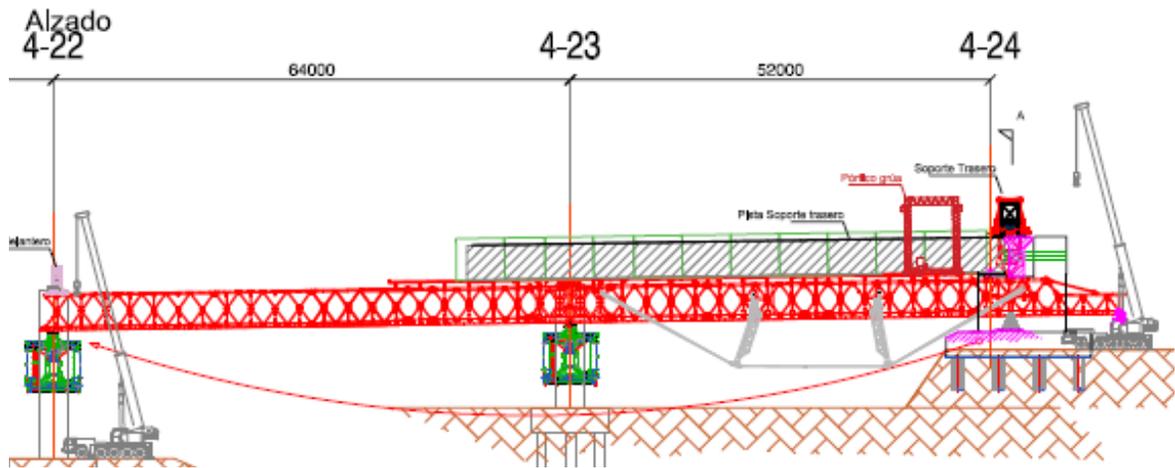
Movimiento de ménsulas para avanzar la celosía y armado de pórtico trasero para sostenimiento sobre el tablero colado
